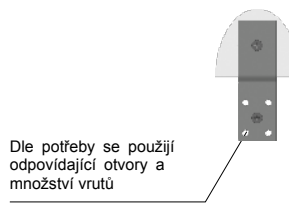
Šachtová konstrukce - instalační rám E1 - ČTYŘHRANNÁ Klapka
